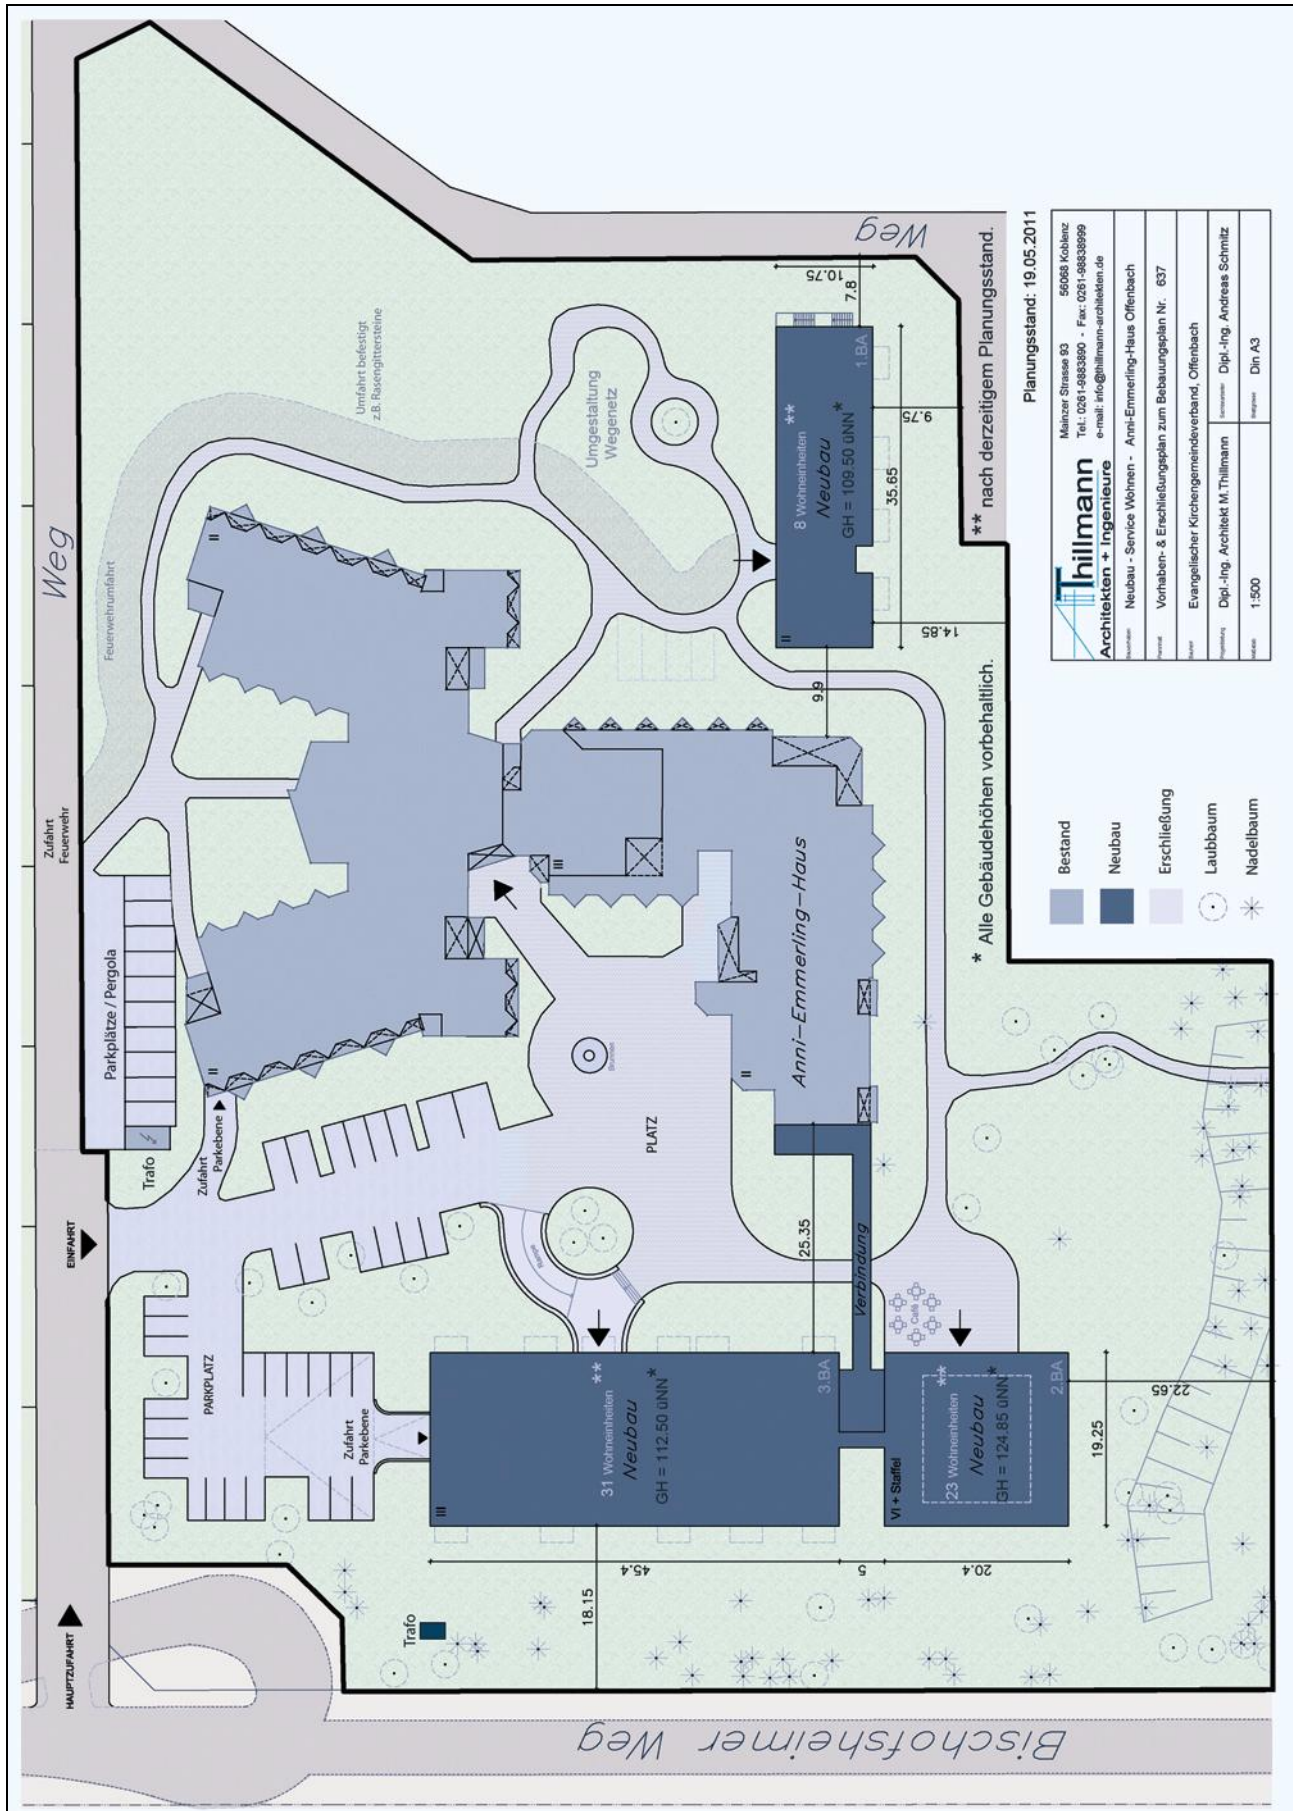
Lageplan der vorgesehenen Bebauung (o.M.)
